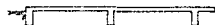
LOSA CON TRABES HACIA ARRIBA
